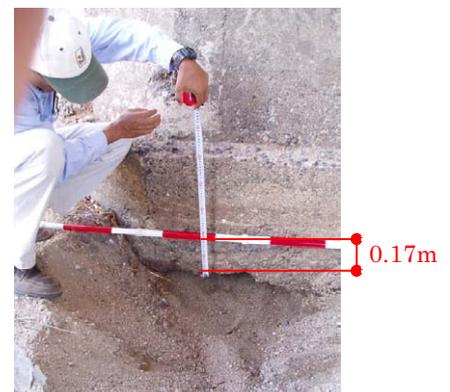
Profundidad de desplante de la Cimentación del Estribo A2
